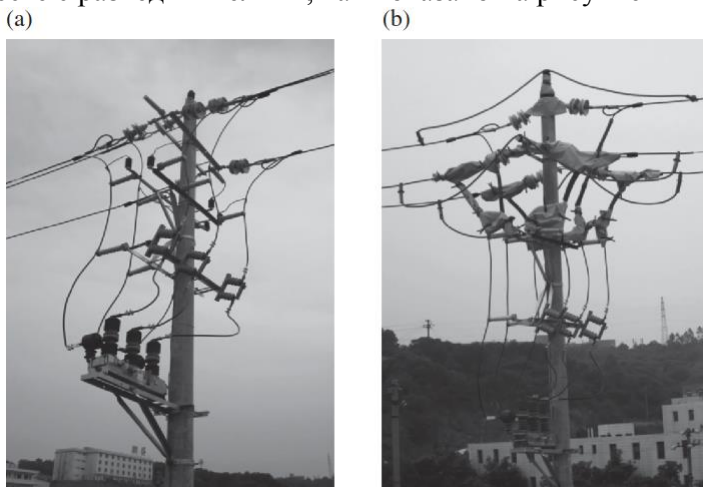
Замена расцепителей, установленных на опоре (I). (a) расцепители, установленные на опоре; (b) установка изолирующих покрытий и байпаса прокладка маневровых проводов.
